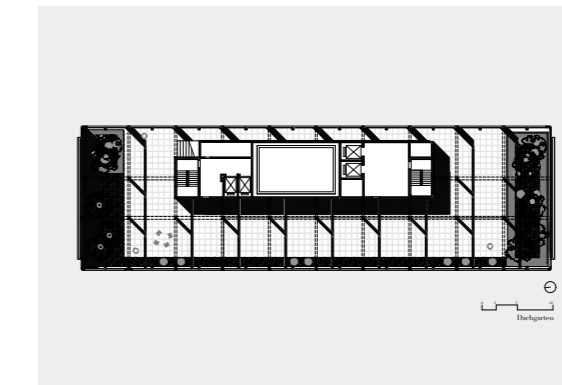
, 16: Grundrisse Dachgeschoss
